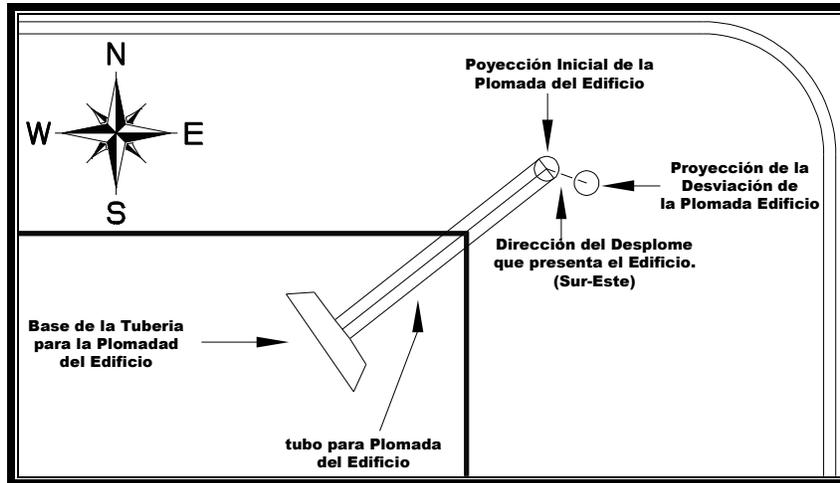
Desplome lineal del Edificio. Vista Planta.
